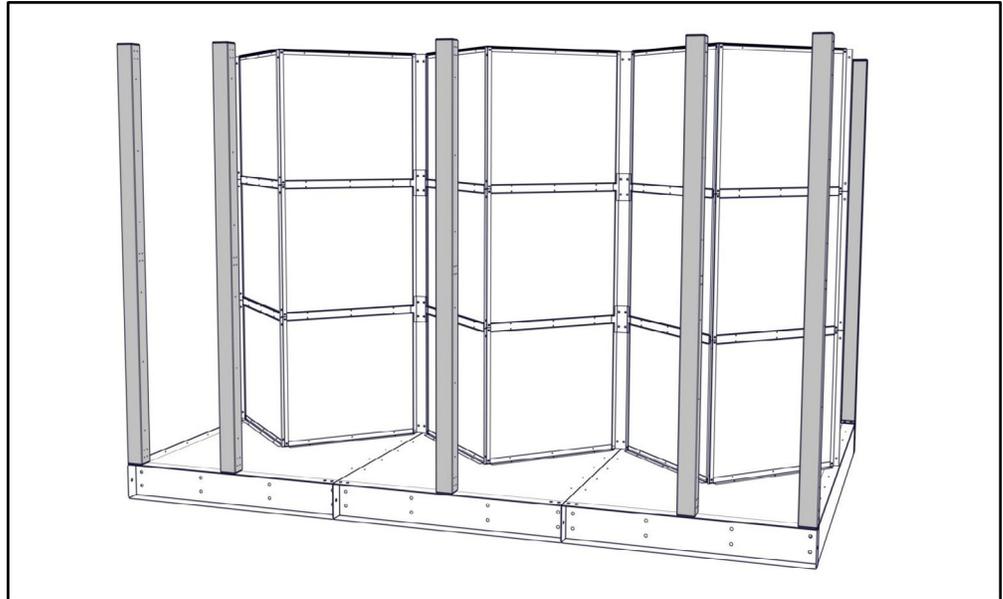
INSTALLATION DES POTEAUX
